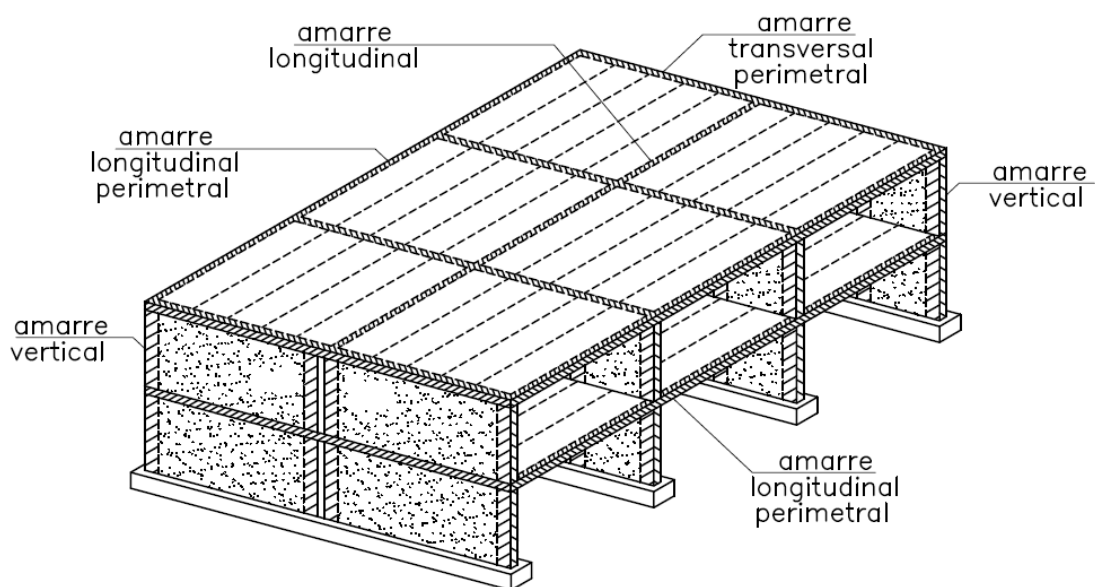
Disposición de amarres de tracción en estructuras de paneles prefabricados.
